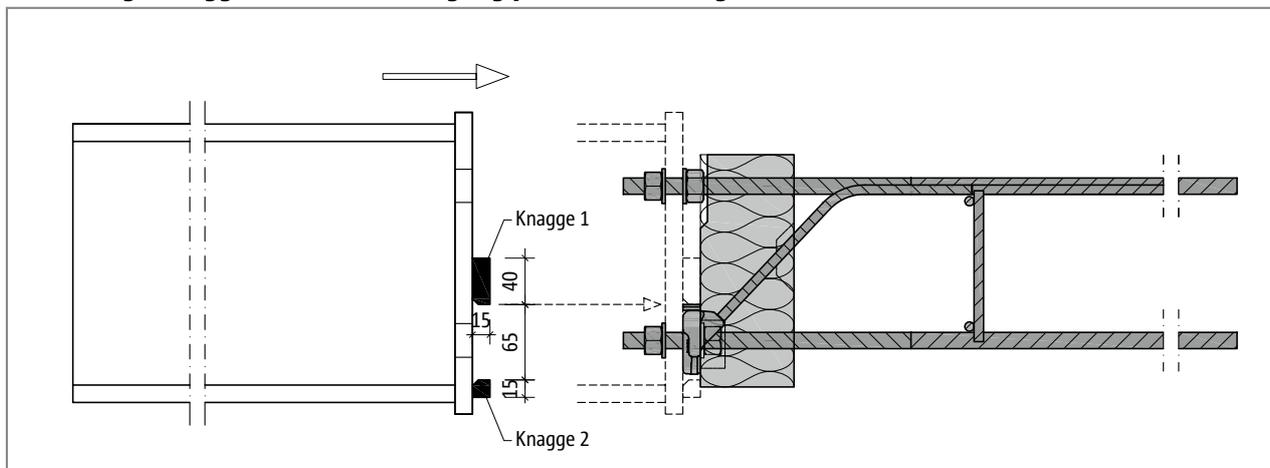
Schöck Isokorb® T Typ SK: Montage des Stahlträgers
